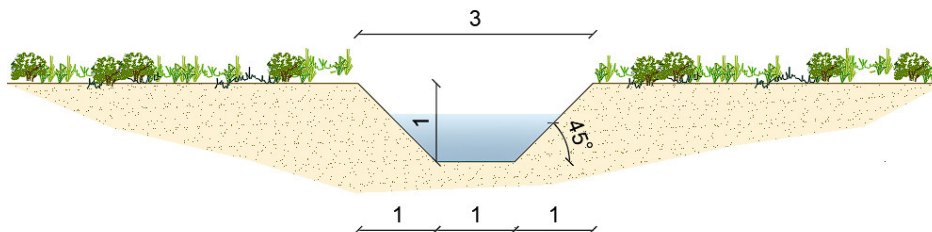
Sezione trasversale del canale in progetto "Tipo 2"
